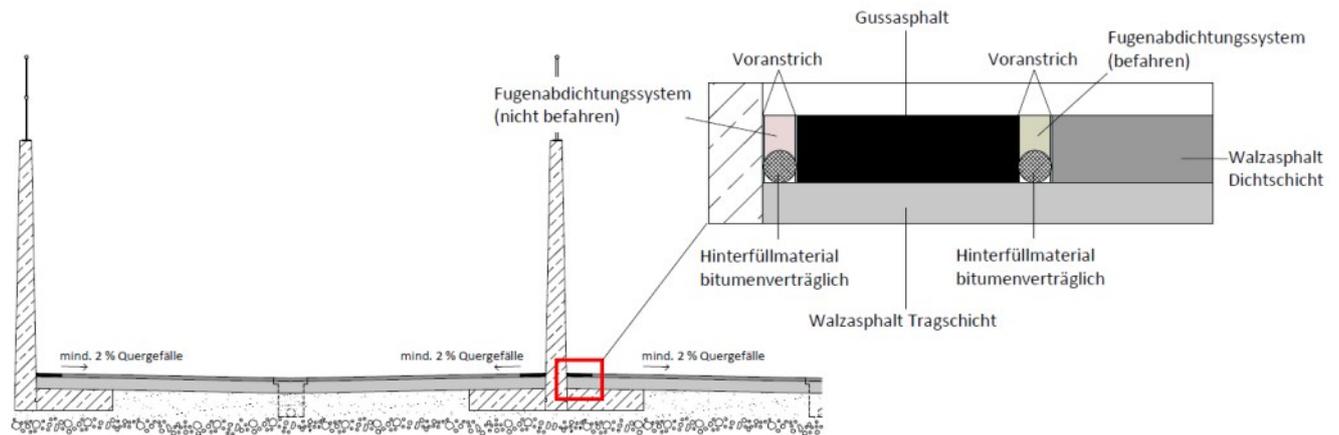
Asphalt - Betonfertigteile (gerade Wand) mit Ortbetonfuß
